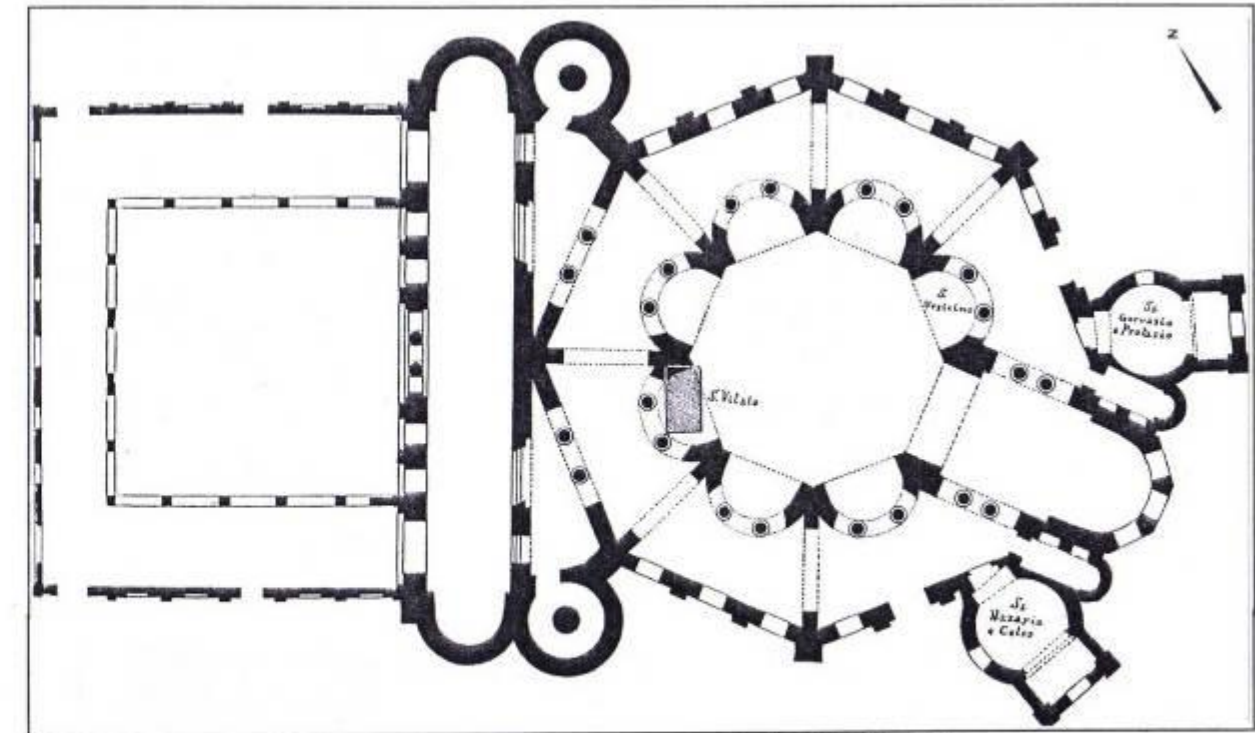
San Vitale, Ravenne, plan d'après GEROLA, 1913.
